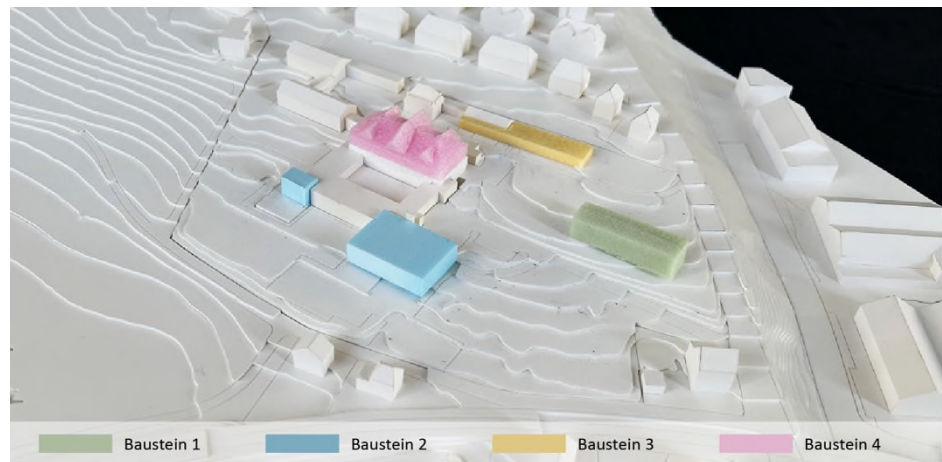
Modell mit Bausteinen, Quelle: Ergebnis Workshopverfahren vom 1. Dezember 2022, rolf mühlethaler architekt bsa sia
